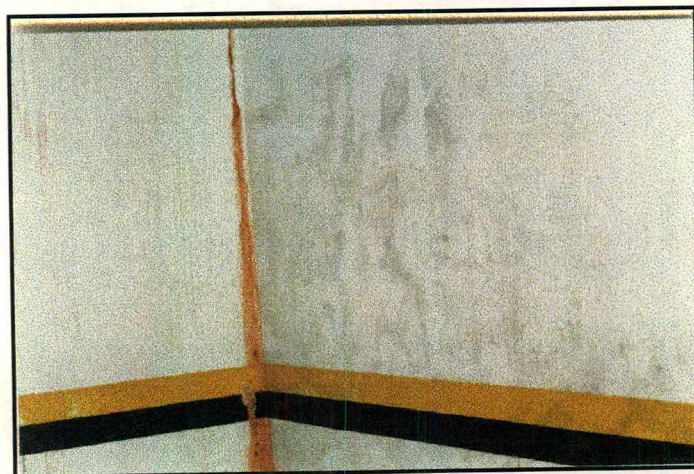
Manchas de infiltração nas paredes da garagem - pavimento do subsolo
